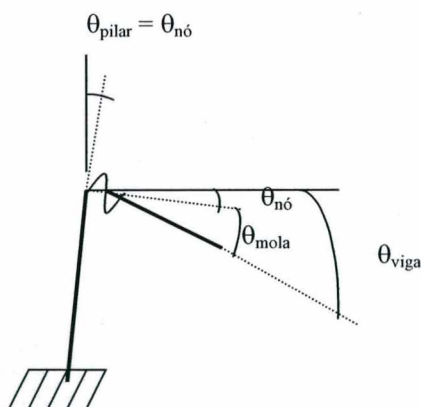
Configuração deformada ampliada da conexão viga-pilar para “mola” na viga.
